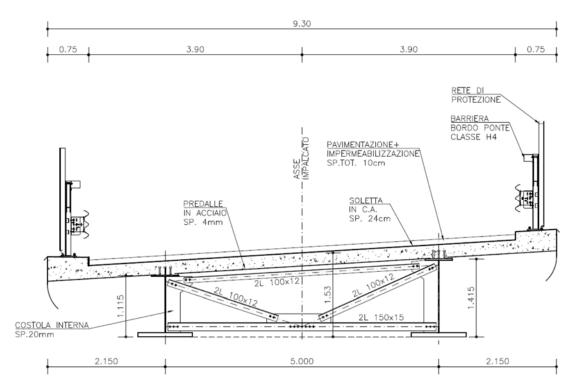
Sovrappasso di uscita – sezione trasversale tipo dell'impalcato
